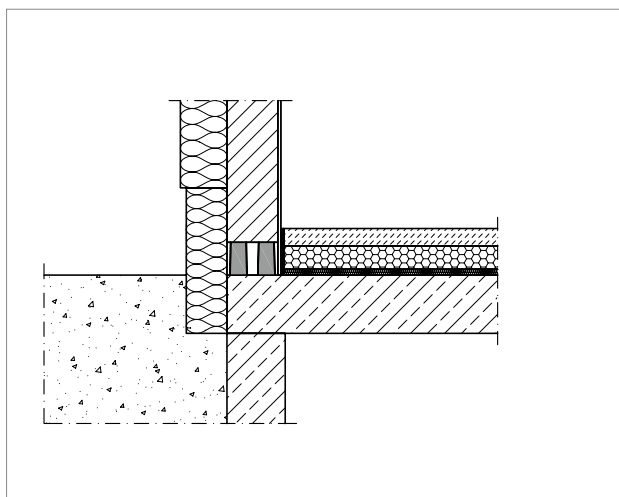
Effiziente Wärmedämmung mit Schöck Sconnex® Typ M
